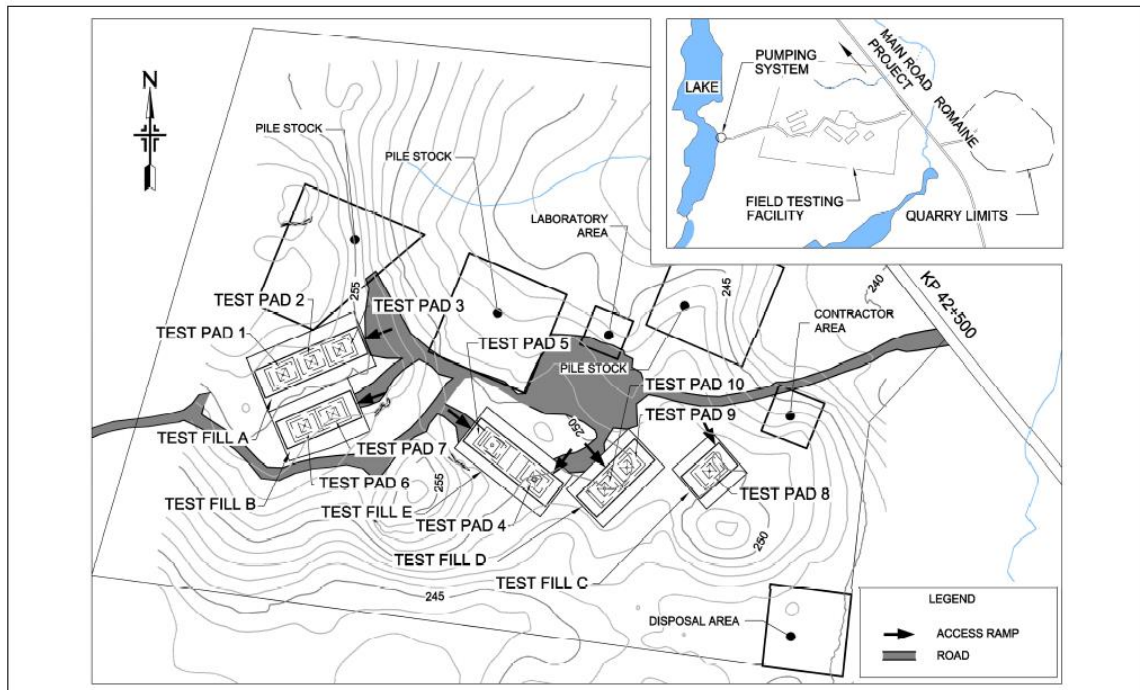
Configuration du site d'étude des planches d'essai (Verret *et al.*, 2013)
